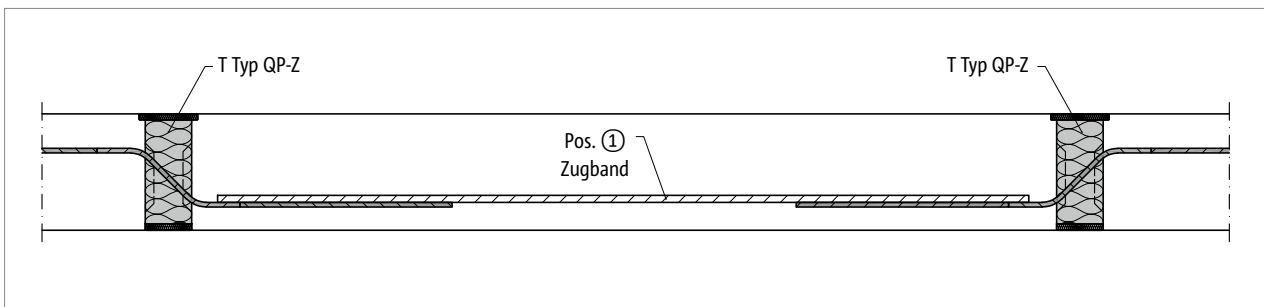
Schöck Isokorb® T Typ QP-Z: Schnitt A-A; Bewehrungsanschluss Zugband
